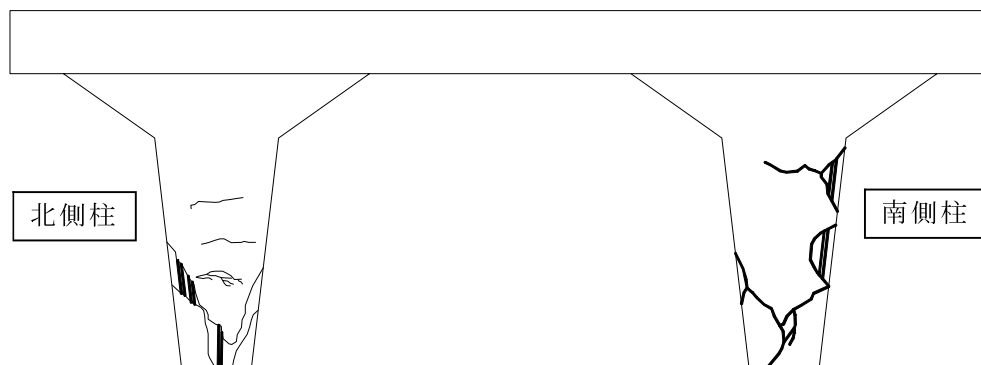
Moorhouse Avenue Overbridge の全体概要と被害箇所・状況
